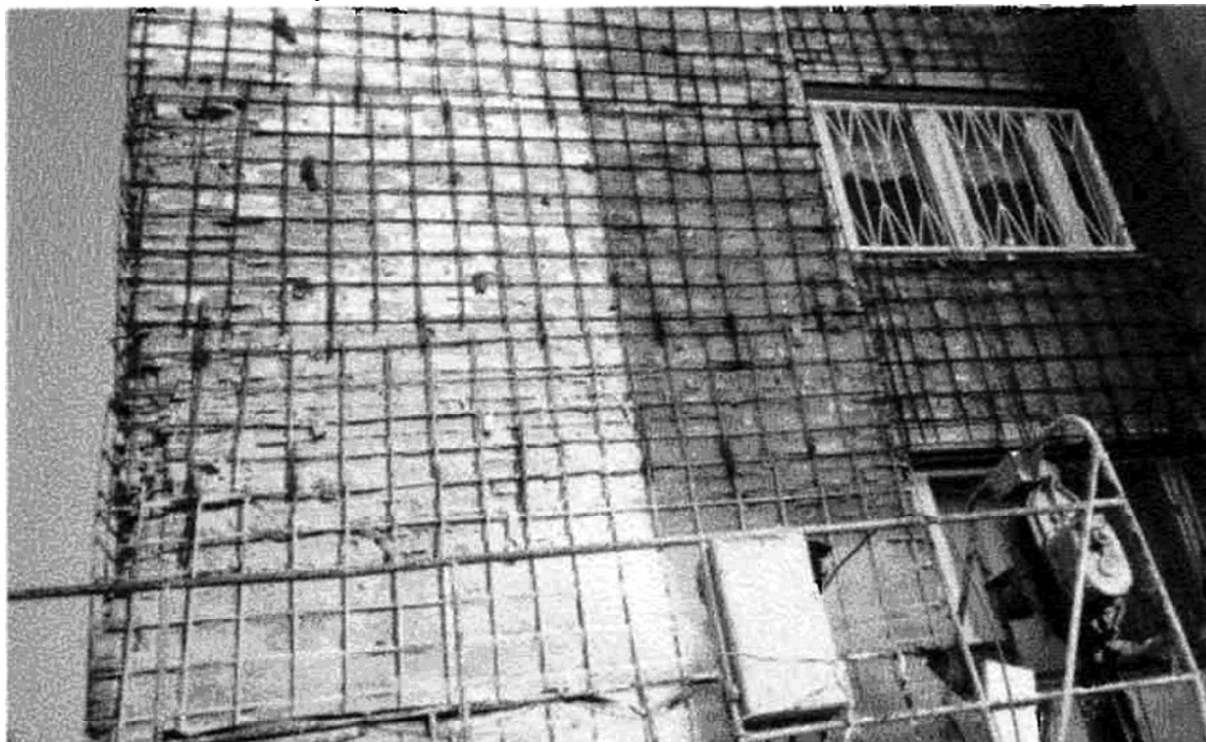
Усиление каменных стен устройством железобетонной рубашки
